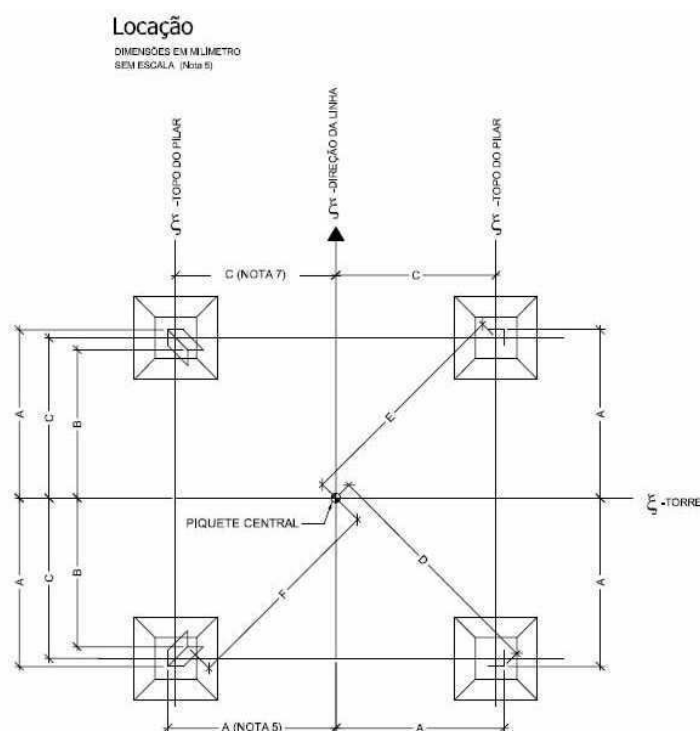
Detalhe da locação de cavas para instalação de sapata para estrutura metálica autoportante do tipo A21d (Chesf, 2008).
